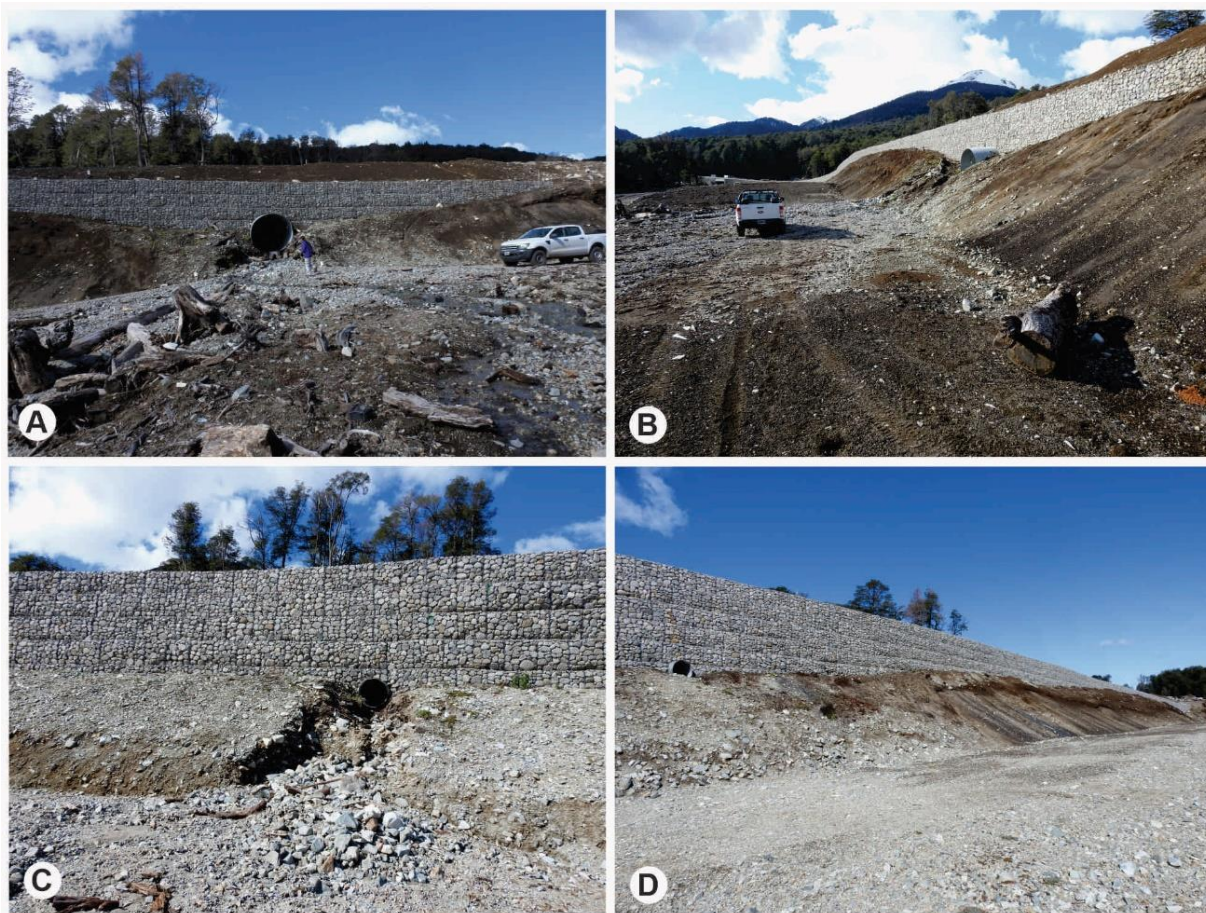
Vista de algunos de los ductos de alcantarillado y de drenaje vial que desembocan hacia el área del Macrolote 5. A) y B). Distintas vistas del ducto de alcantarillado del Arroyo Florencia Sur. C) Ducto de alcantarillado de cauce intermitente (sin nombre). D) Vista de uno de los ductos de drenaje vial ubicados sobre el sector (aún no habilitado).
